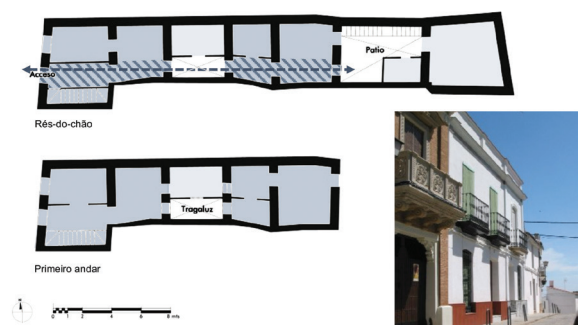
Casa na praça de Santa Ana 9, Constantina (Ficha NU-AE-242, escala 1/250, PGOU de Constantina, revista pelos autores)
